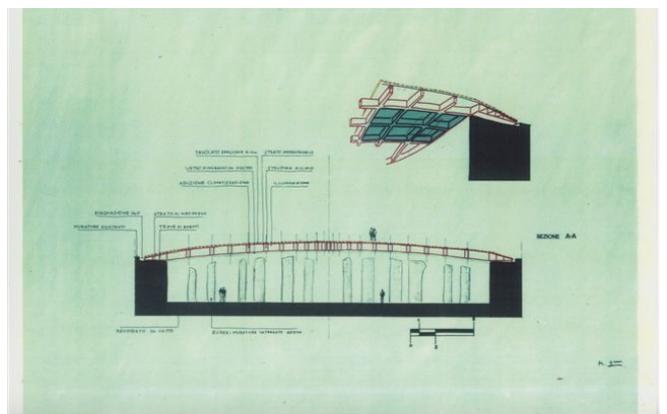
M. D'Olivo intervento di restauro del Colosseo. particolare della pavimentazione. Scala di rappresentazione 1: 100
